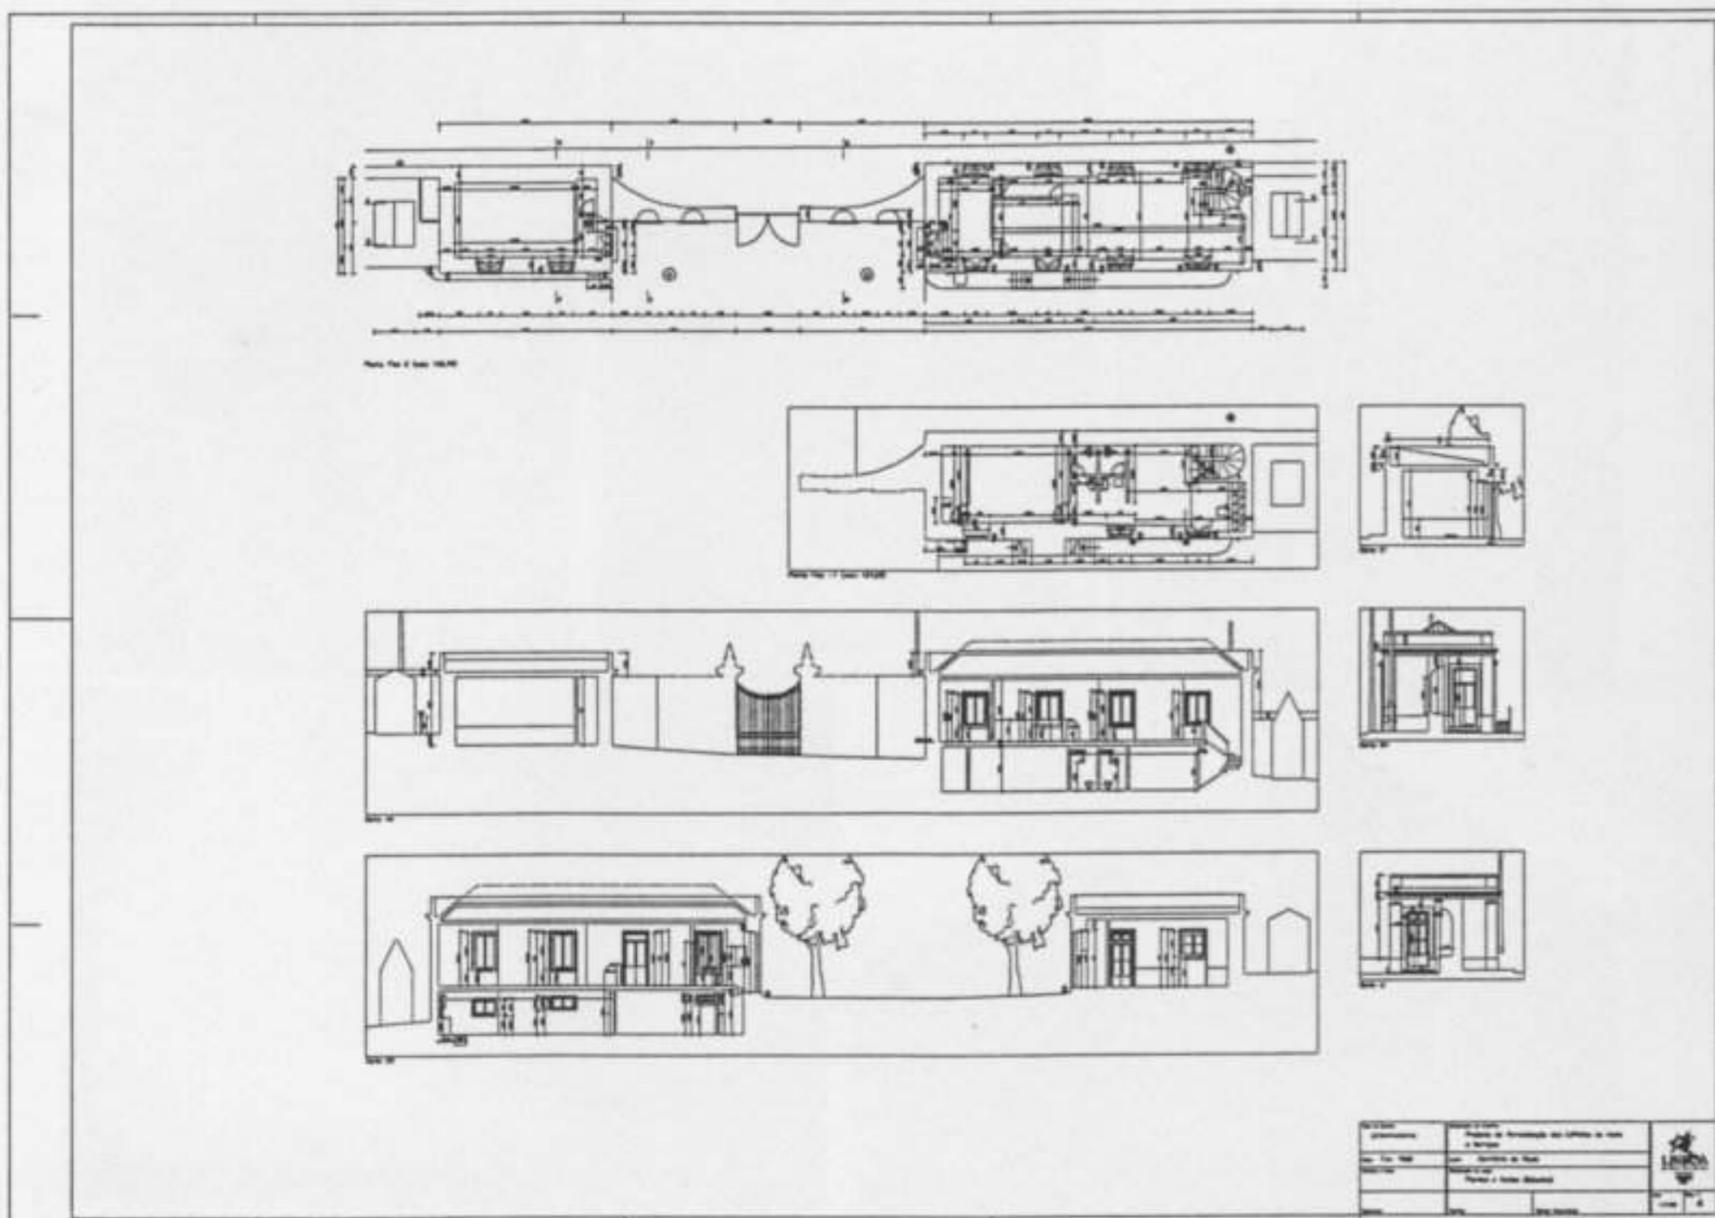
Levantamento - Plantas e Cortes Cotados - Esc. 1/100 - Des. nº 4.
